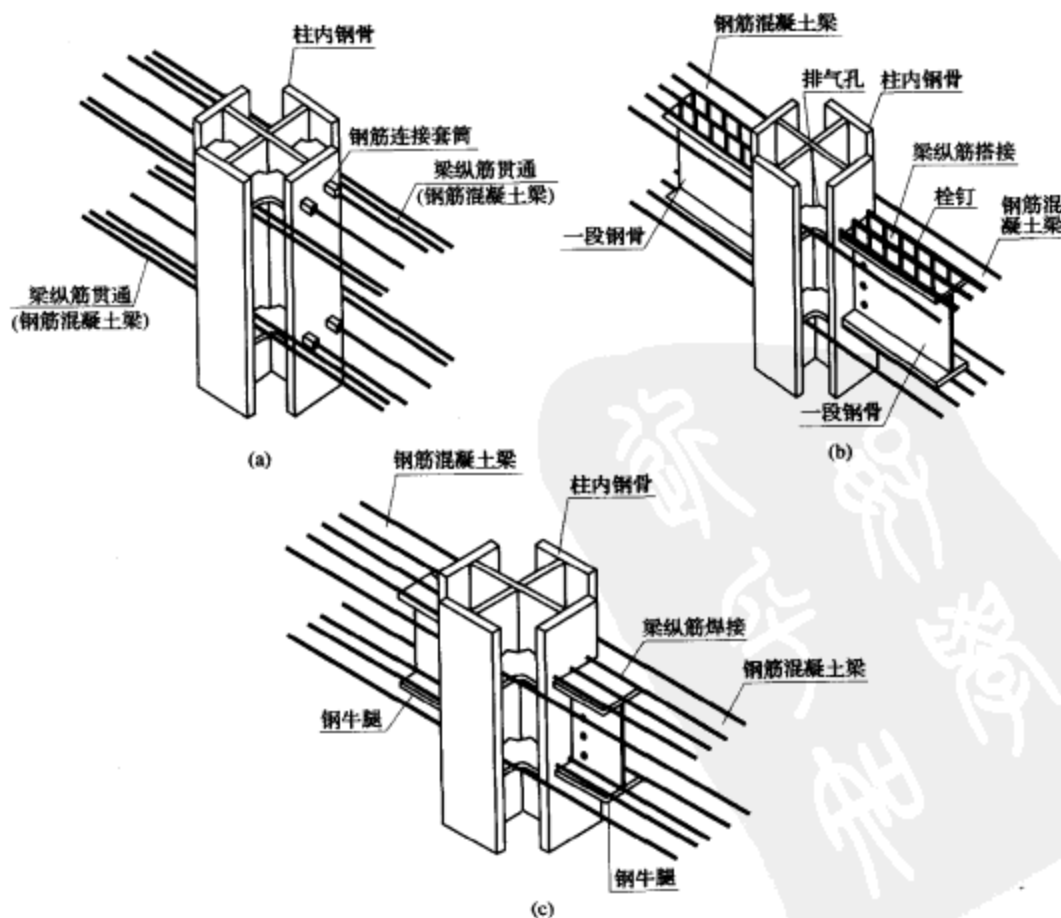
钢筋混凝土梁与钢骨混凝土柱连接构造
